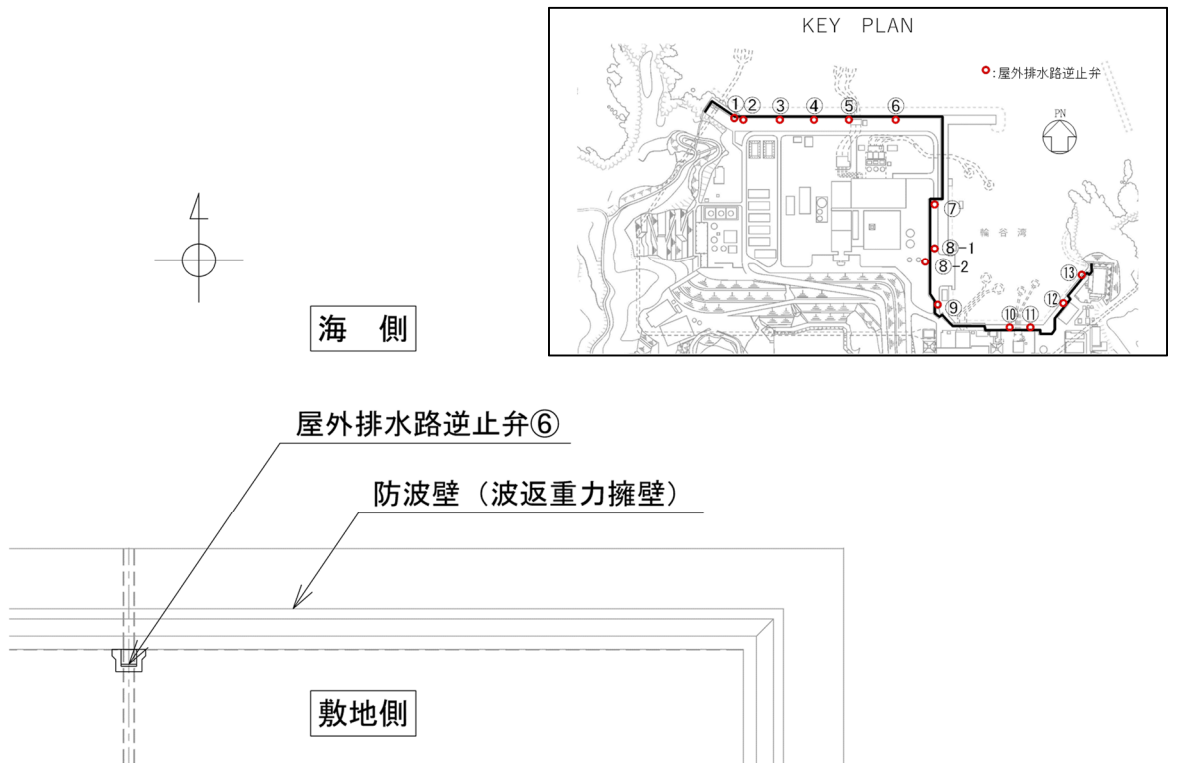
(1) 屋外排水路逆止弁⑥平面图
